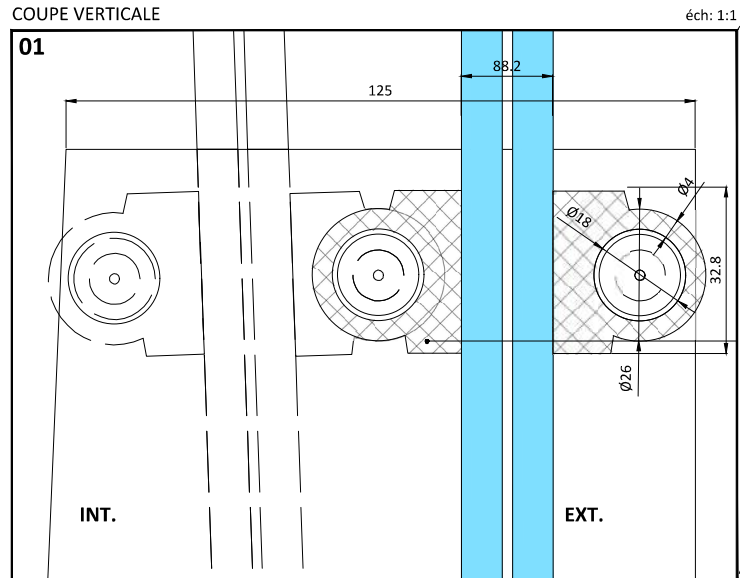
### DETAIL EXISTANT SUR CLAVETTE COUPE VERTICALE
